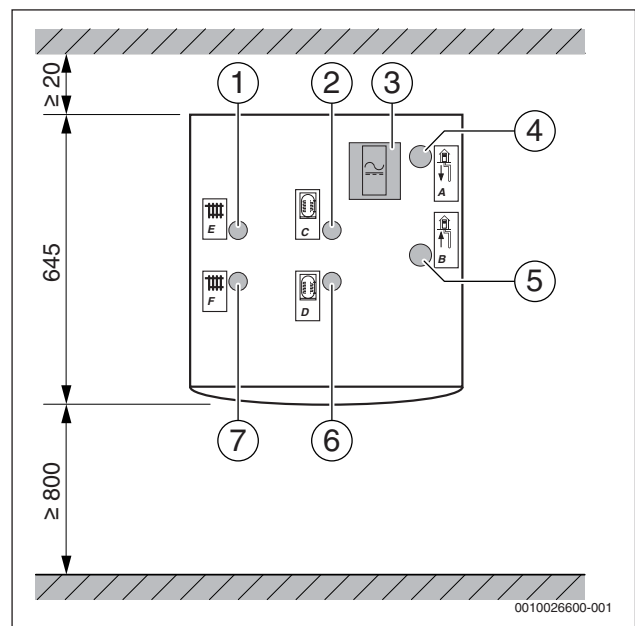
Abmessungen und Mindestabstände WPS 6...8-1 (Draufsicht)
